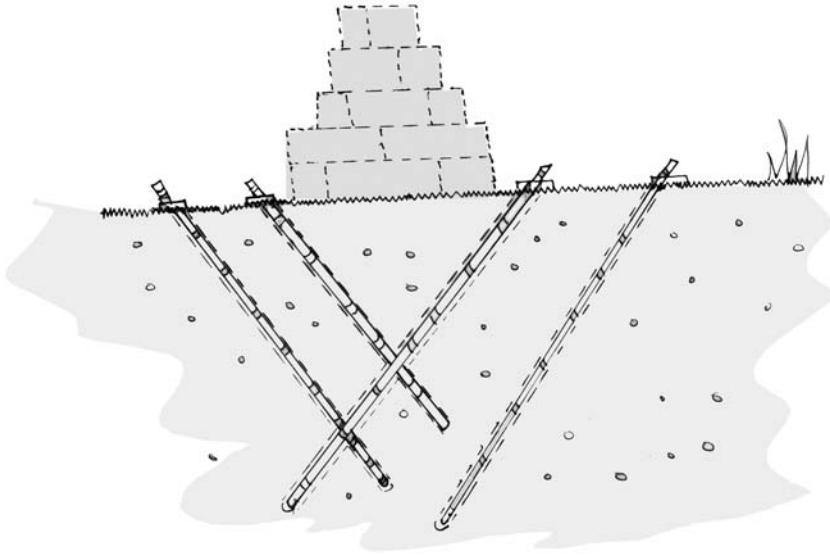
Refuerzo del terreno en cimentación de estructuras.
